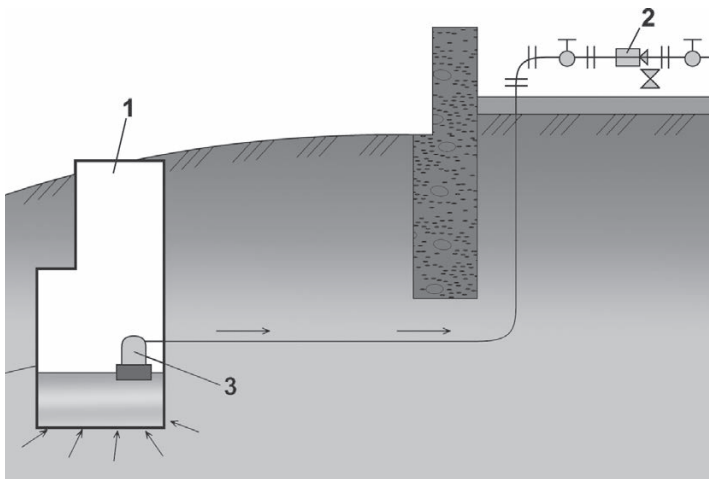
Ввод водопровода в грунт под фундаментом: 1 — каптажная камера; 2 — водомер; 3 — насос
